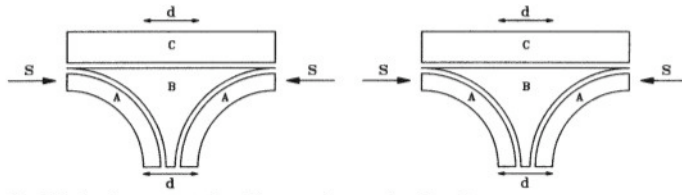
Sezione e proiezione delle strutture interne alla cupola.
